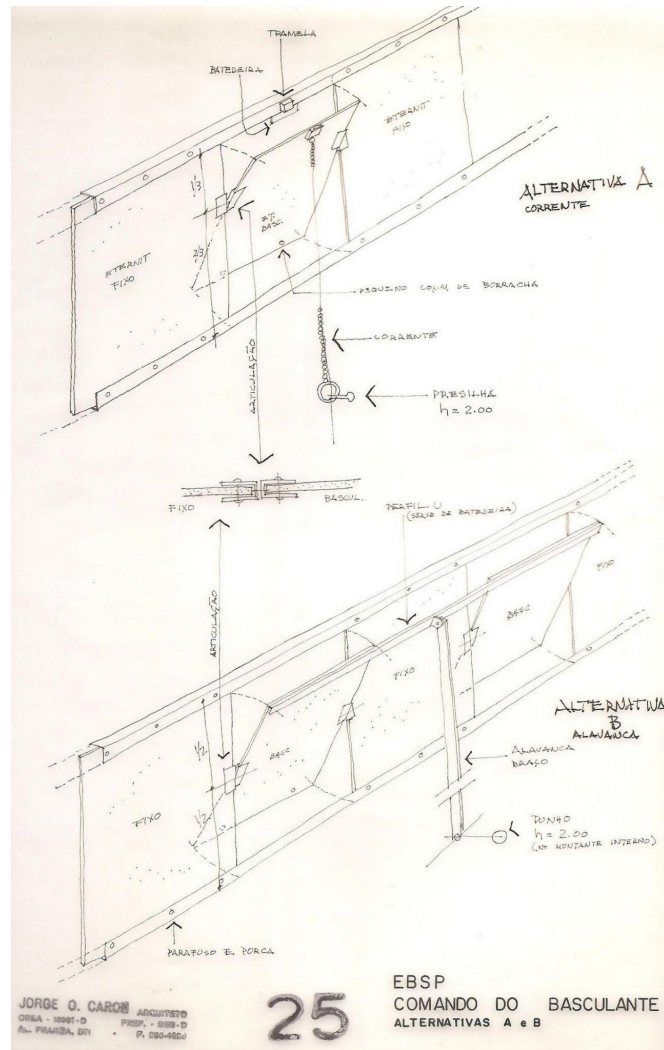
Detalhamento de janela. Fonte: Acervo Jorge Caron, (2021).
